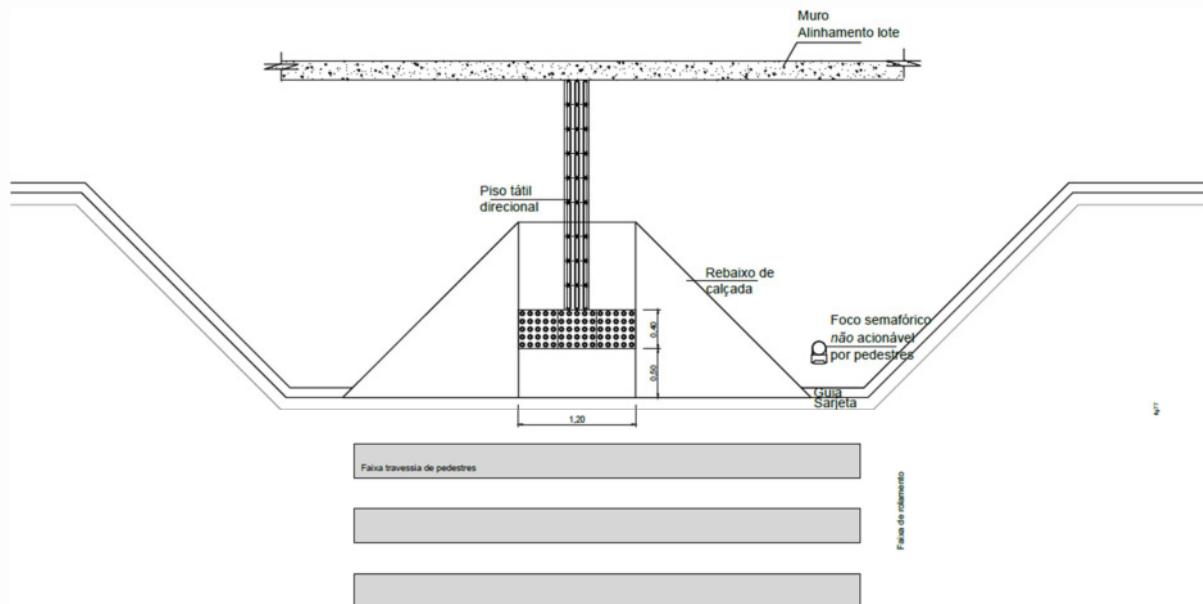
Redução de percurso de travessia com rebaixamento de calçada
